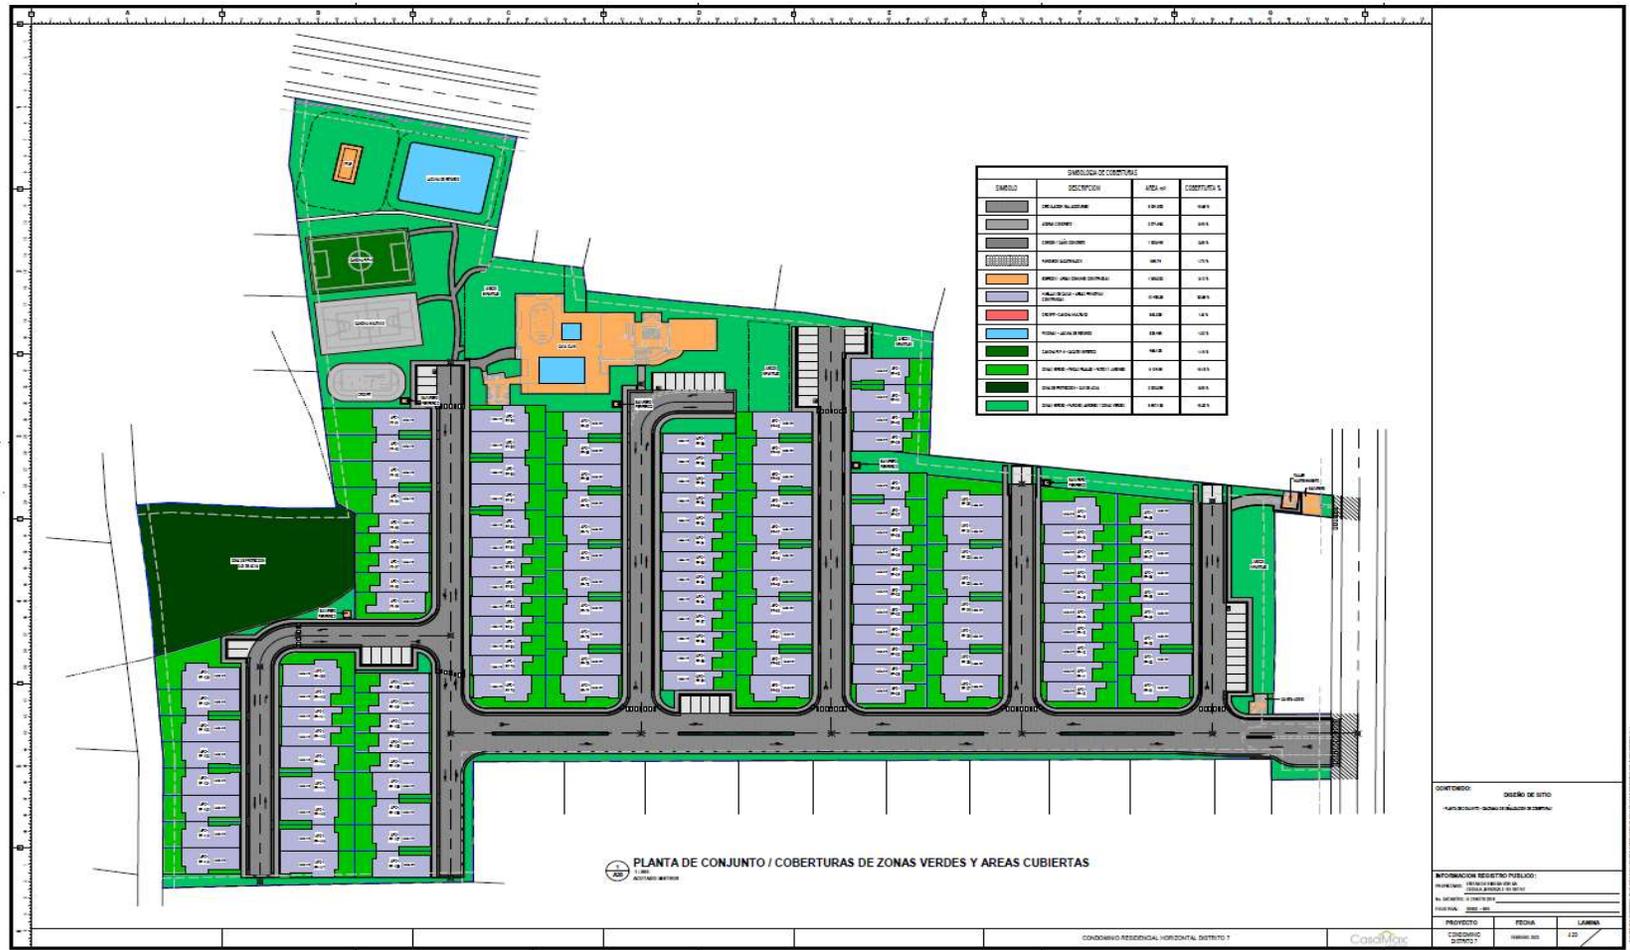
Diseño de Sitio Coberturas. Fuente lámina constructiva # A20.
